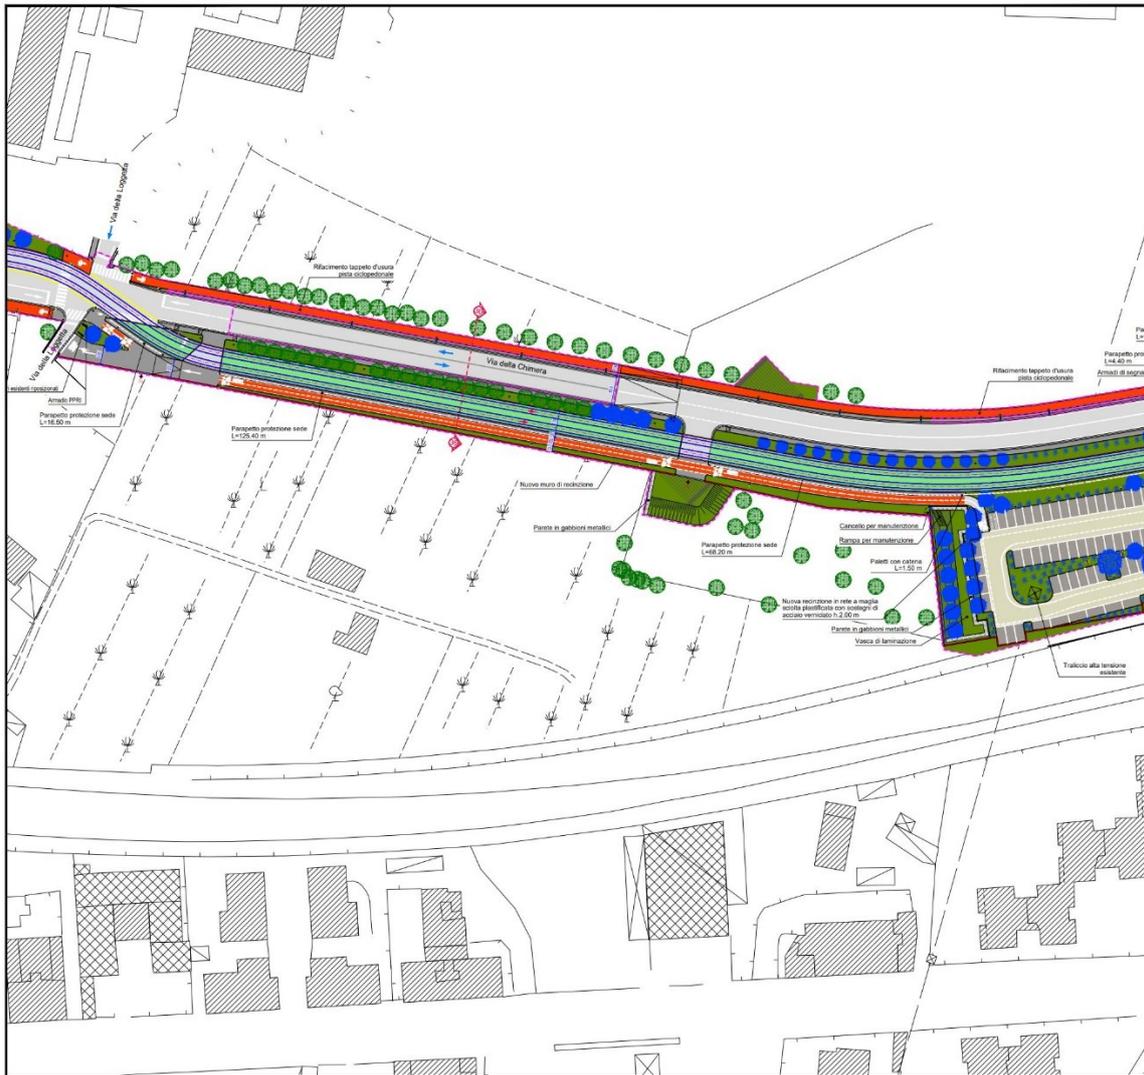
Progetto area di via Chimera, ingresso campi sportivi, e predisposizione sottopasso
